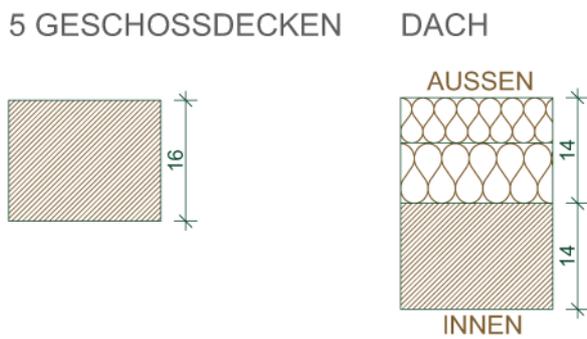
Bauteilstärke Brettsperrholzdecke
